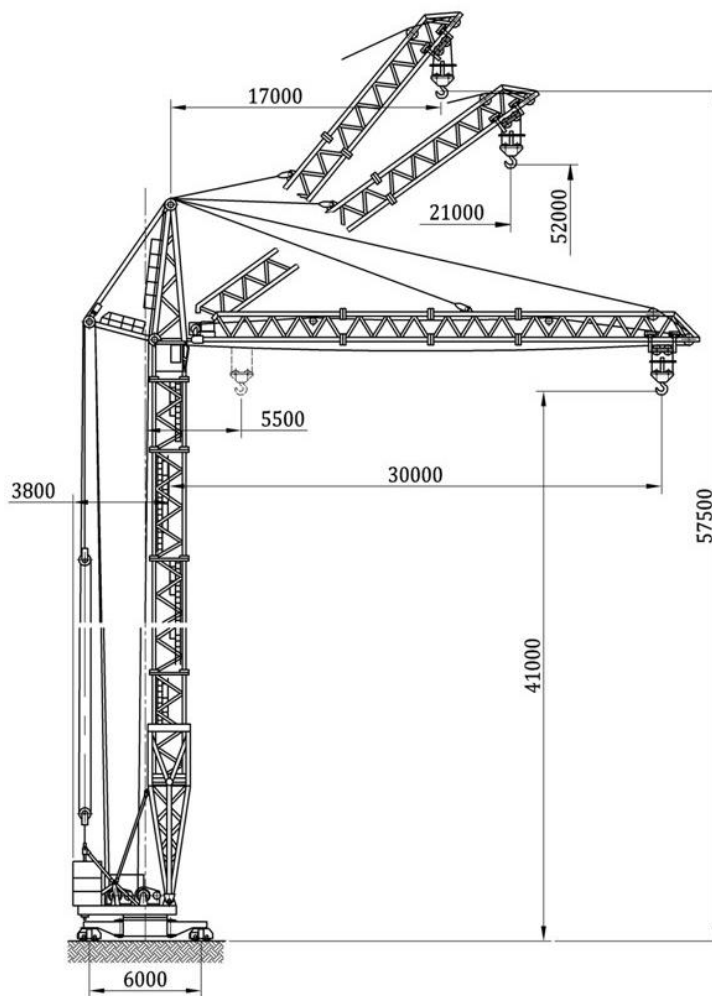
К расчету устойчивости башенного крана КБ – 403
